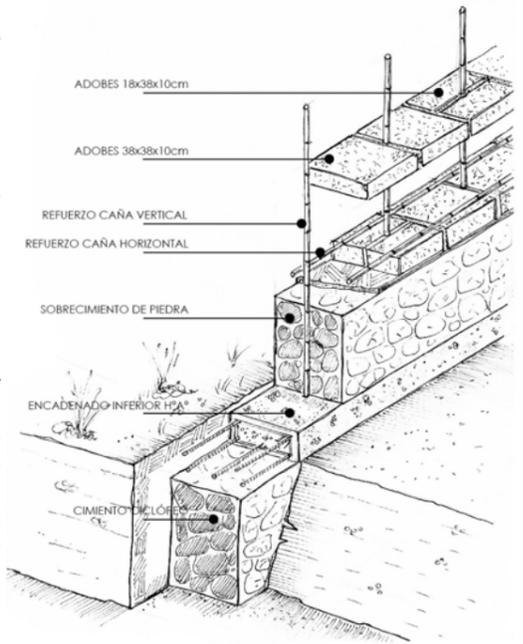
Sistema constructivo de adobes reforzados con entramados de caña y vigas collares de madera sobre cimientos de piedra (Fuente: croquis de los autores)
